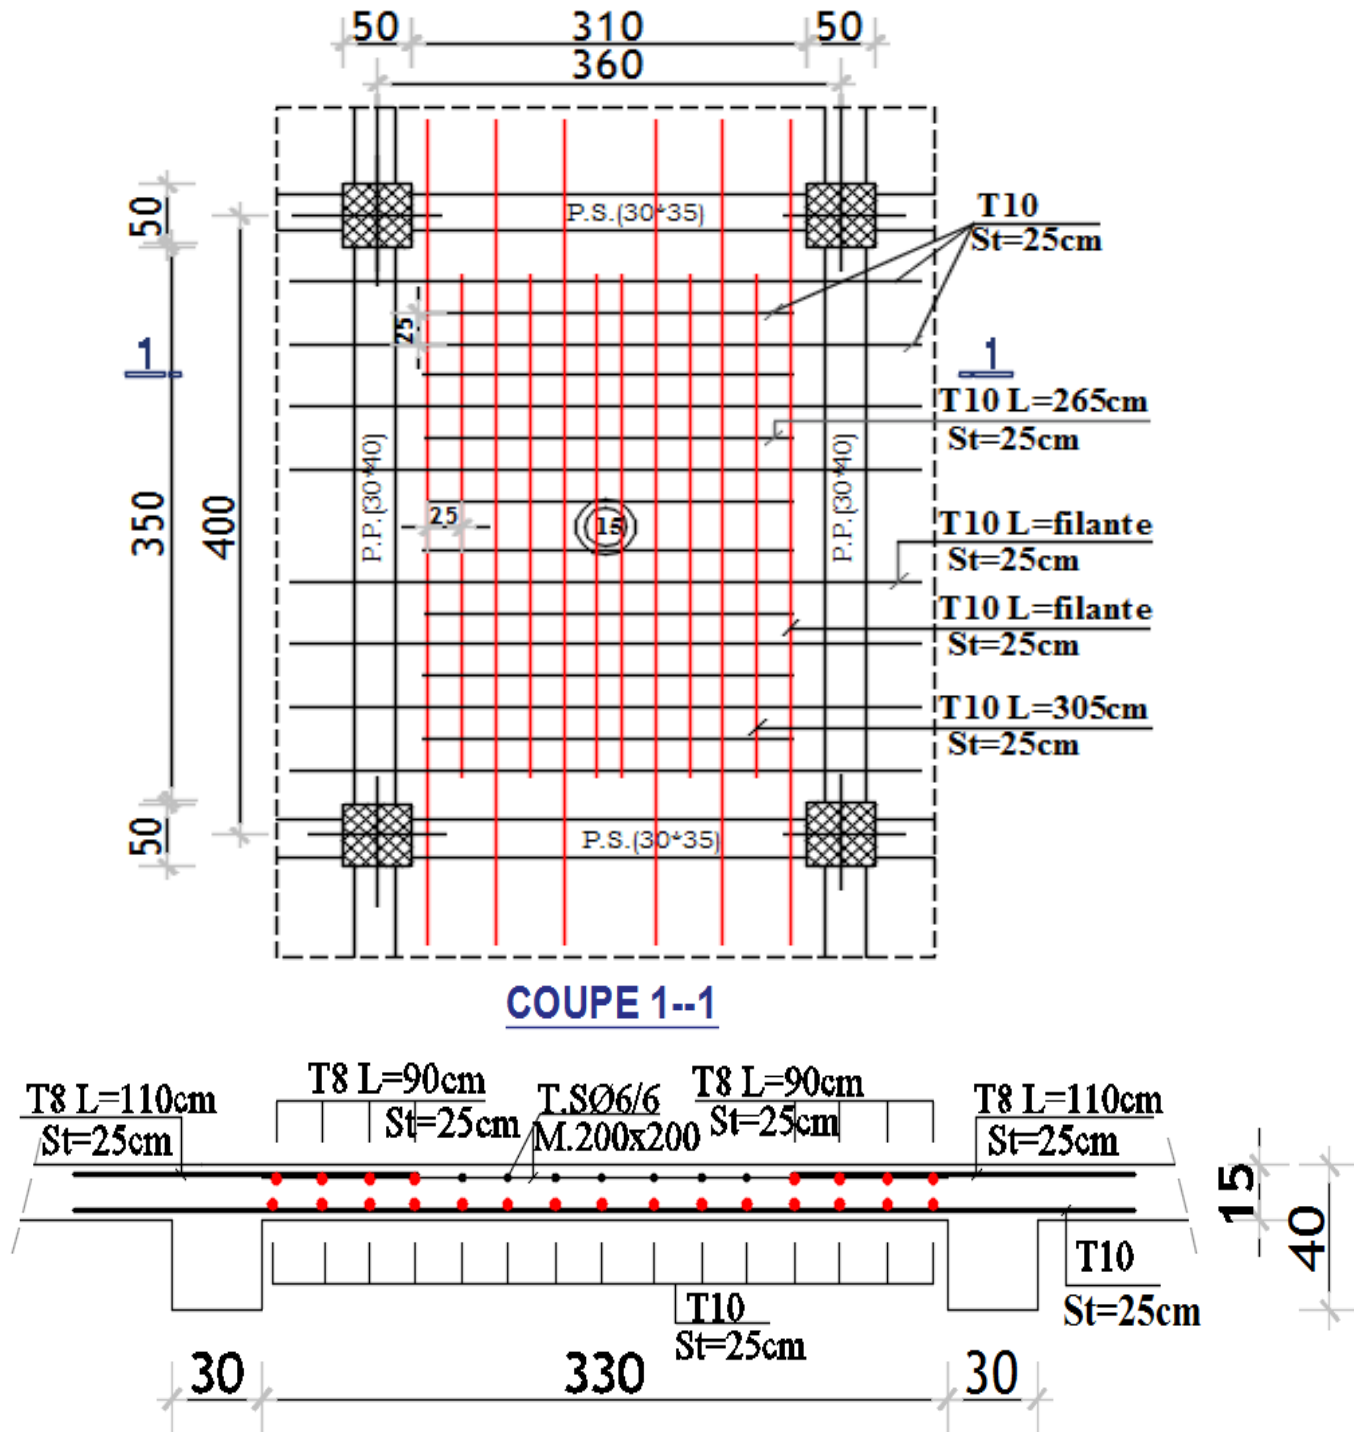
Schéma de ferrailage de la dalle pleine (RDC).
